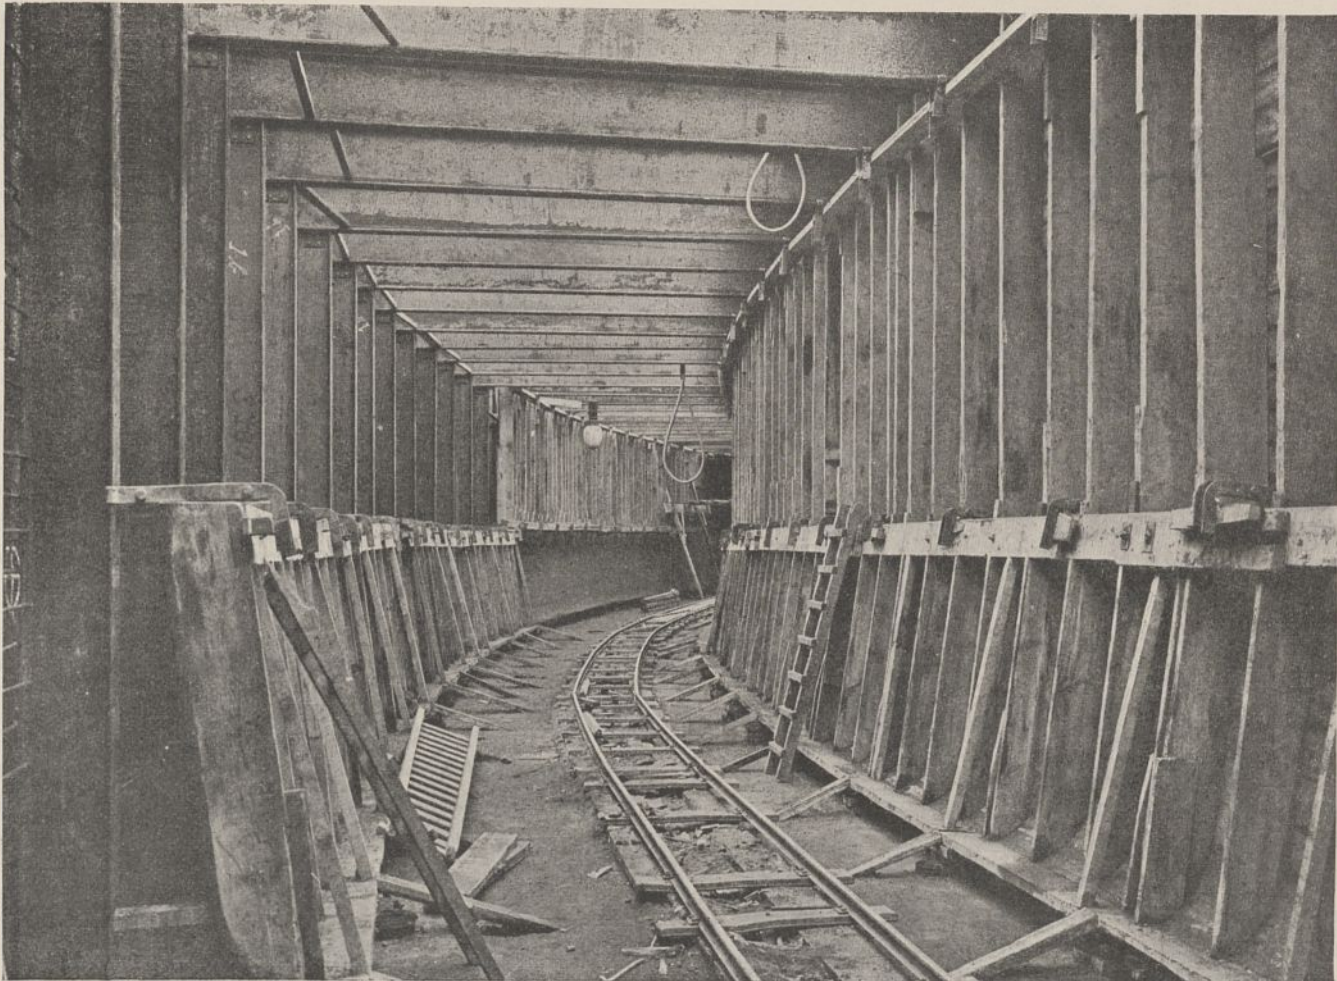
Herstellung der Wänden im eingleisigen Tunnel (Verbindung mit dem Betriebsbahnhof).
